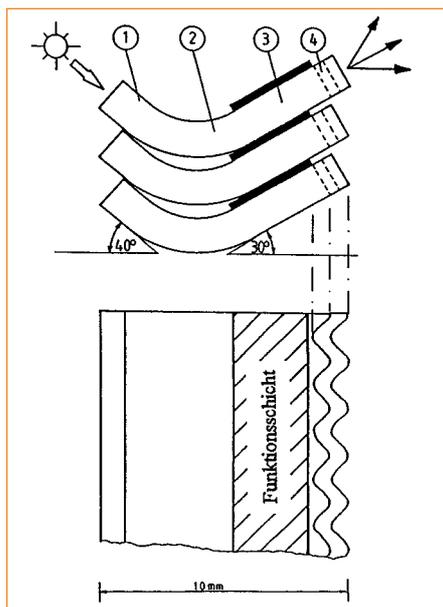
Aufbau des Lichtlenkprofils mit Funktionsbereichen
